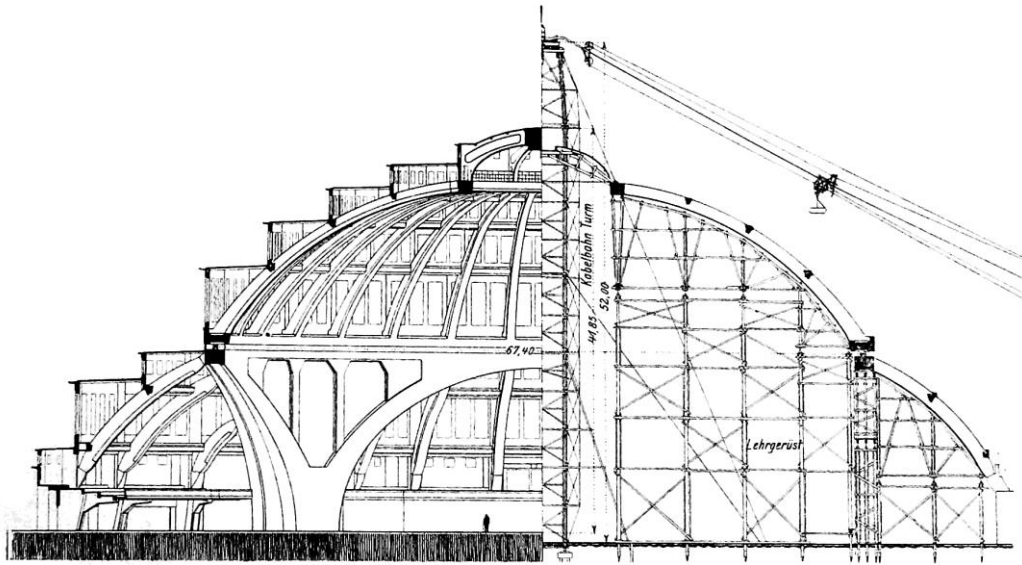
Längsschnitt: Bauwerk und Lehrgerüst samt Kabelbahn-Turm
